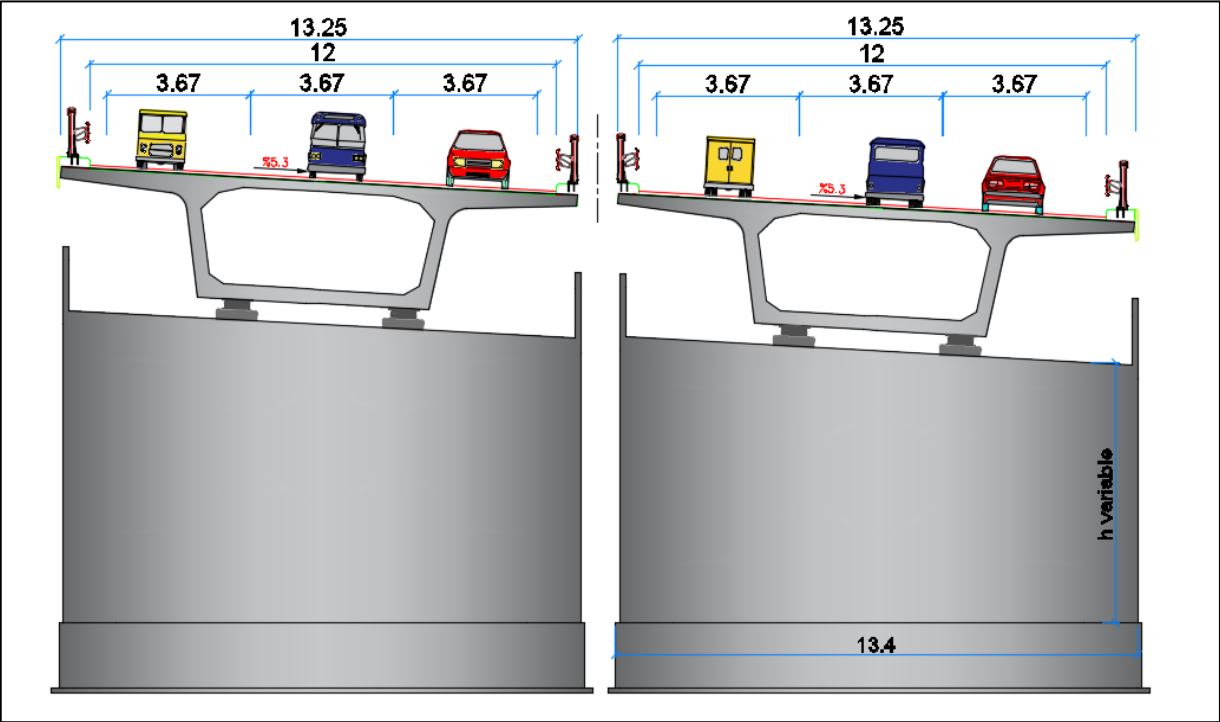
Coupe transversale sur culée VARIANTE 02
